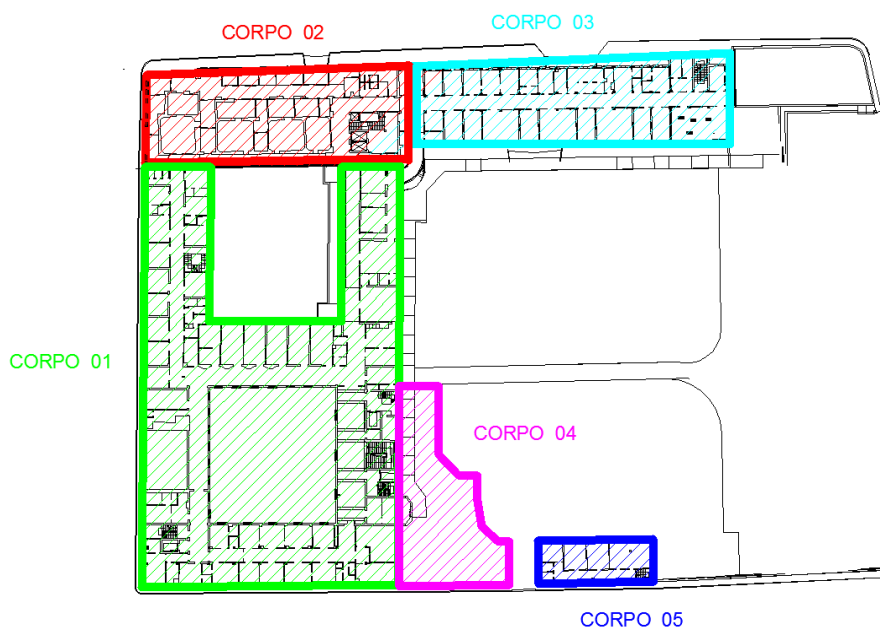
planimetria dell'area e suddivisione dei corpi del complesso ospedaliero, a seguito dei sopralluoghi e oggetto delle presenti verifiche tecniche
